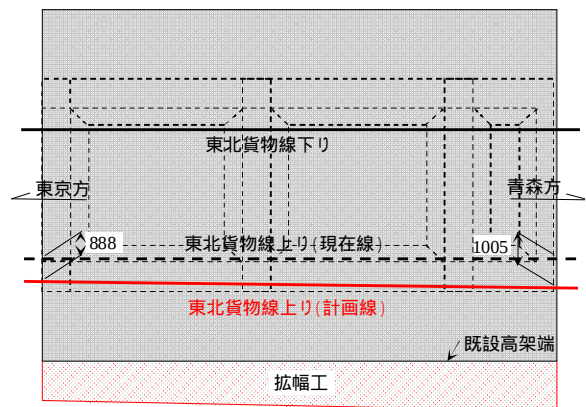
第 1 浦和高架橋 R 1 概略平面図
